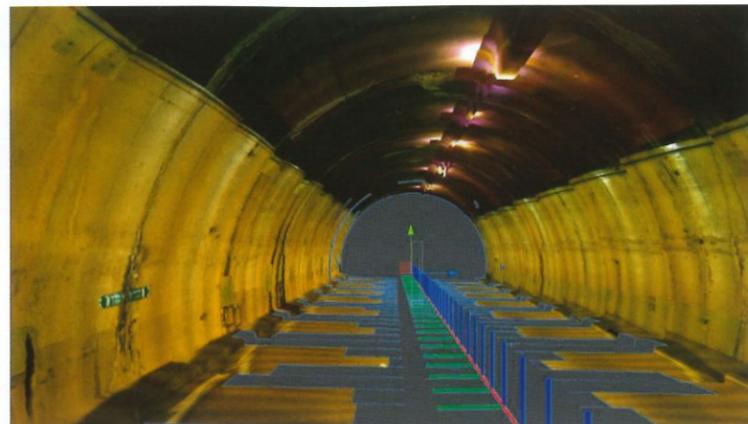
Plaquage de l'acquisition photo HD sur les profils d'un tunnel - HD photo survey over tunnel profiles
